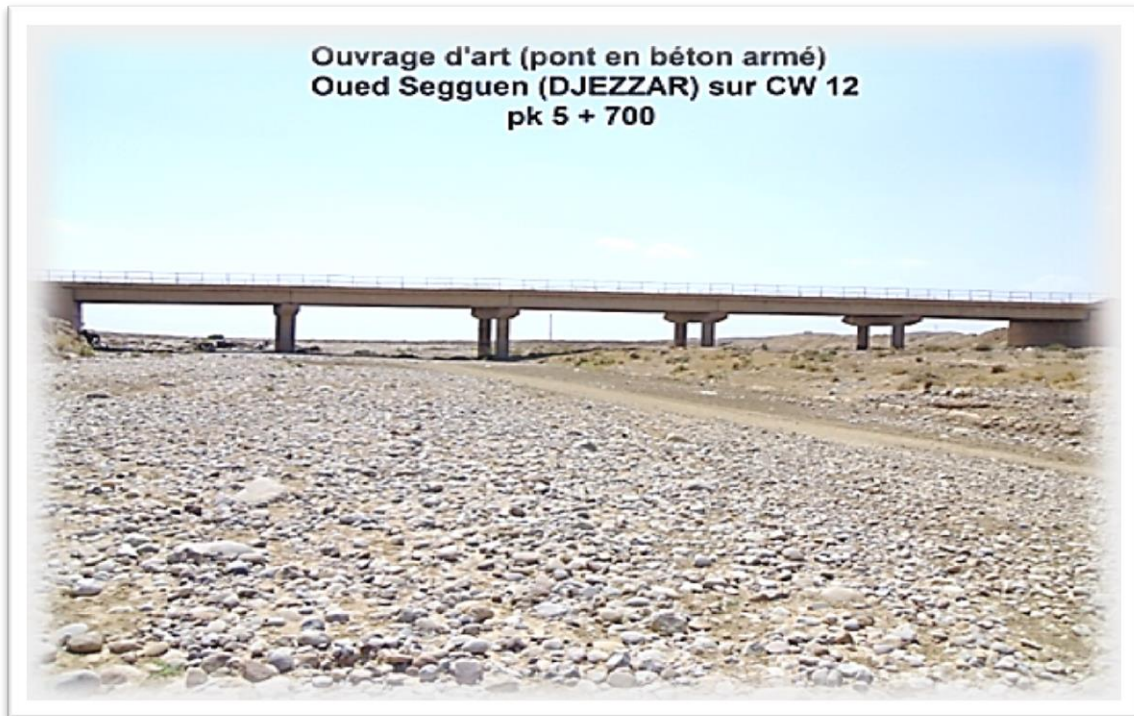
Pont en béton armé à piles circulaires, franchissant oued segguene.
